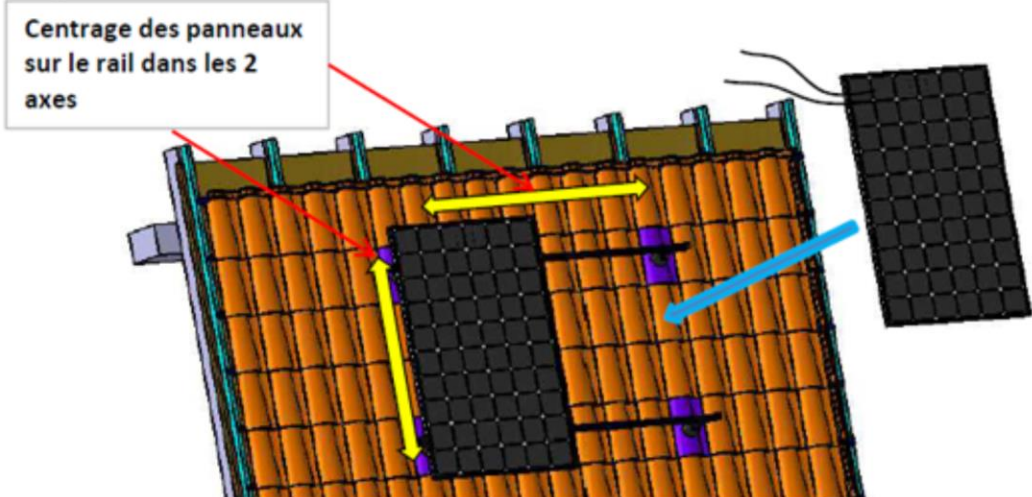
Montage et réglage couvercle et équerre (après repositionnement des tuiles)
